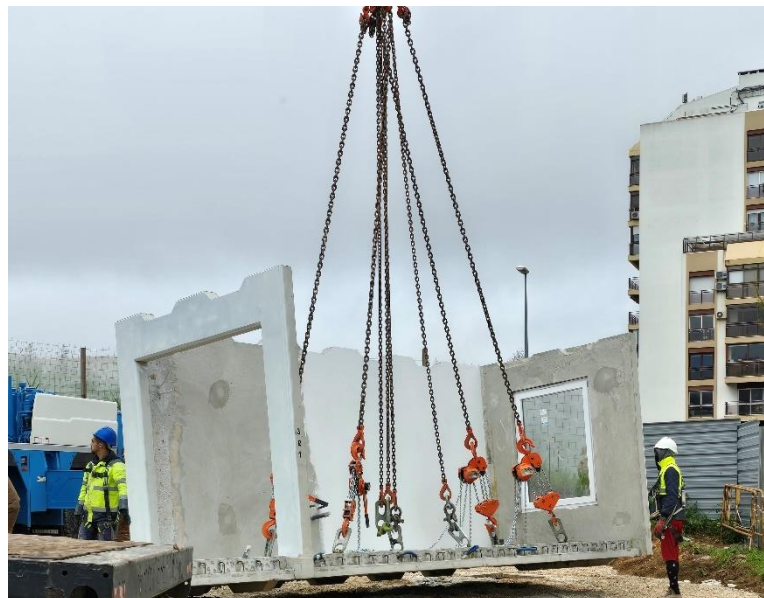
Elevação de um Módulo 3D aberto, em betão
